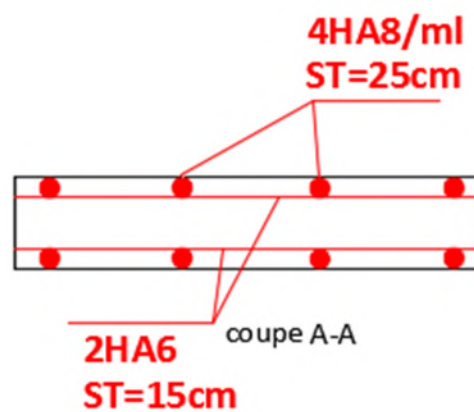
schémas de ferrailage des différents types des poutres de chaînage
